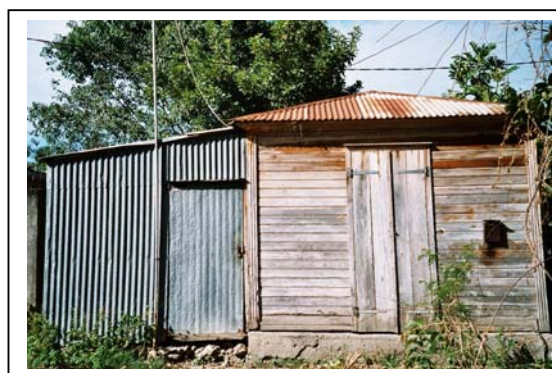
extension horizontale à Bonan Vassor, commune du Moule en Guadeloupe (février 2004)
